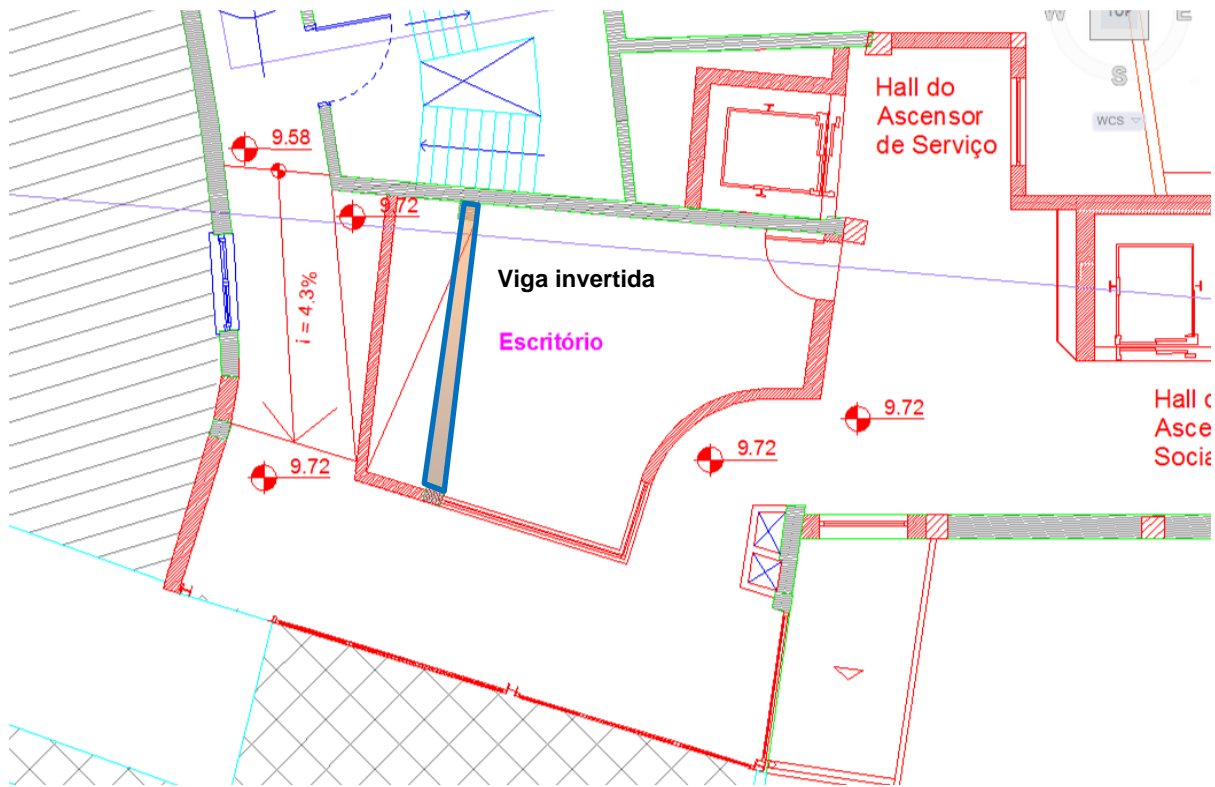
Planta do piso 3 – solução executada na zona acesso entre torre do elevador ao edifício existente
